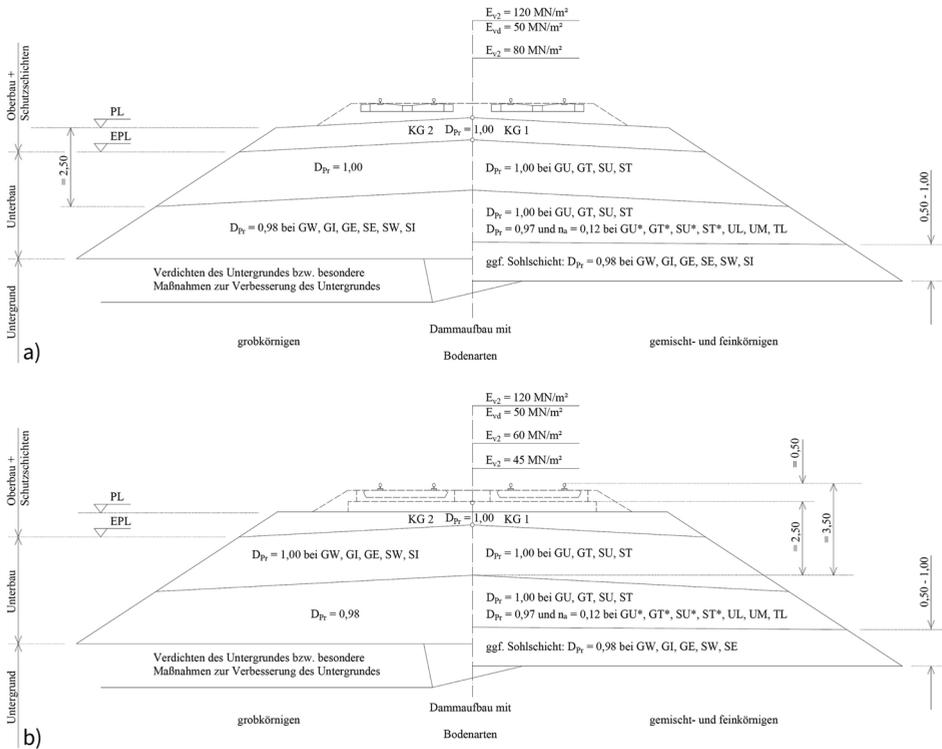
Beispiele von Regelausbildungen des Unterbaus P300 – Damm; a) Schotteroberbau, b) Feste Fahrbahn (nach [46])
